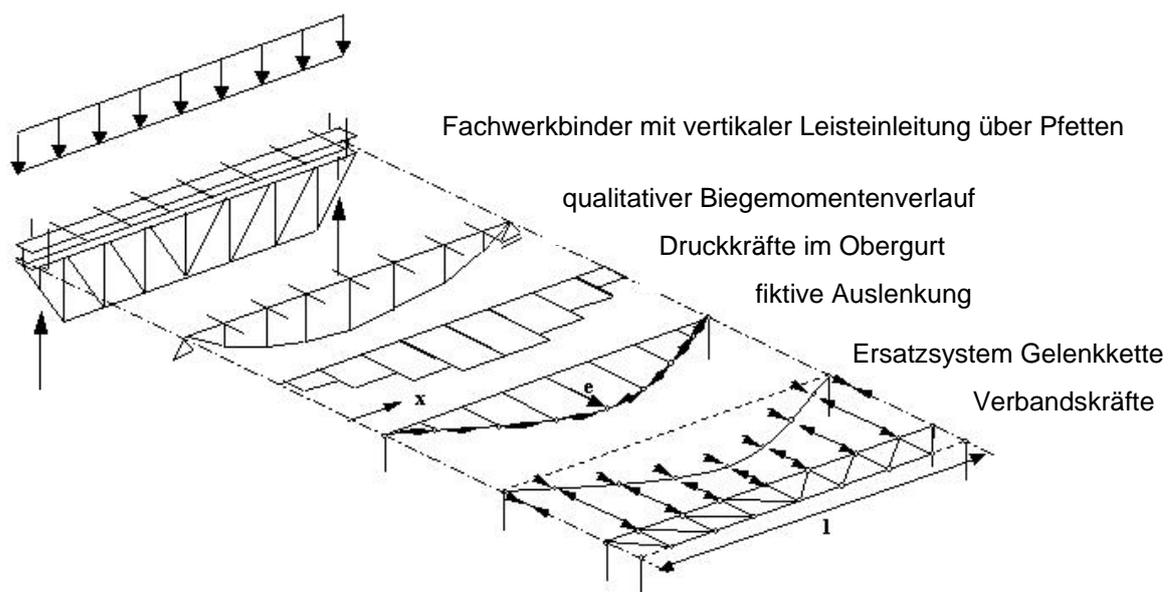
Ersatzmodell für den Nachweis der Stabilisierung des Druckgurts eines Fachwerkbinders
